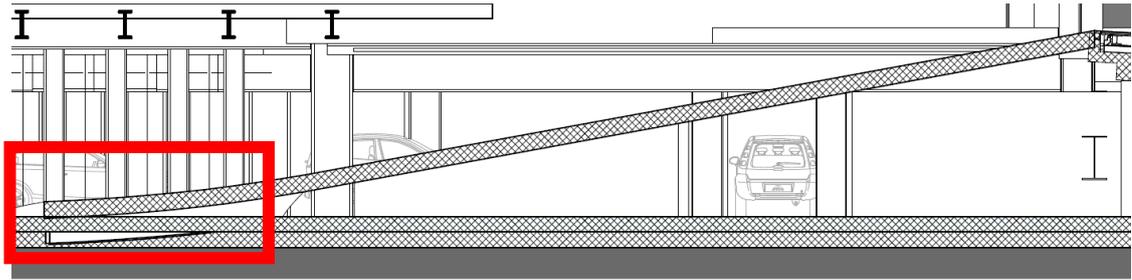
da modello problema posizionamento trave e posizionamento errato della soletta strutturale della rampa di ingresso da piazza Raggi
